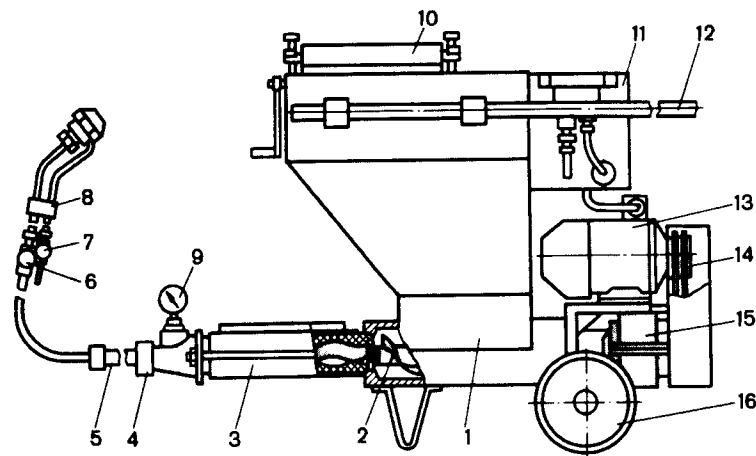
Принципиальная схема агрегата для окраски фасадов зданий
